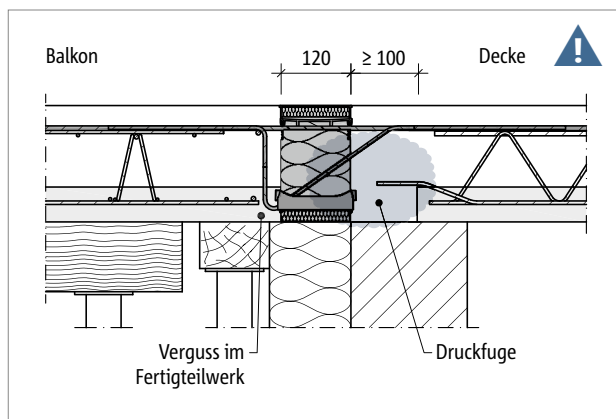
Schöck Isokorb® XT Typ KL: Direkte Lagerung, Einbau in Verbindung mit Halffertigteilplatten (hier:  $h \leq 180$  mm), Druckfuge deckenseitig
